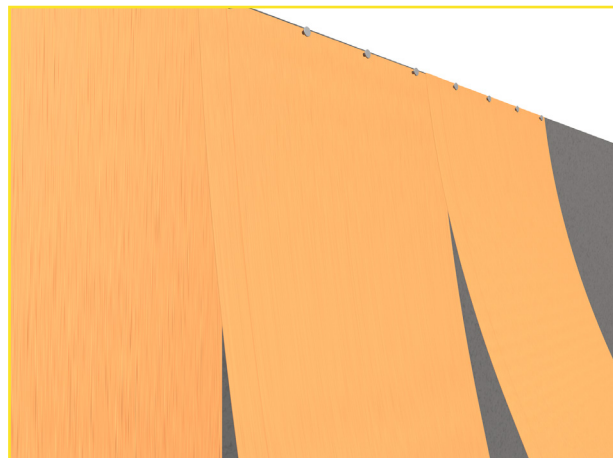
Provisorische Befestigung der Gewebekbahnen
